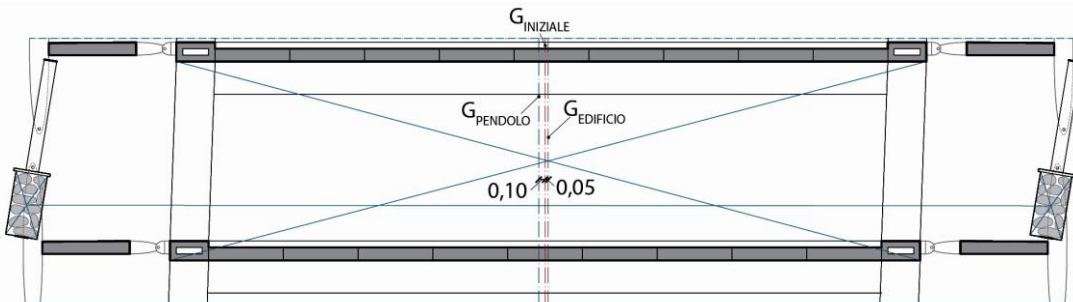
Schema dinamica pendolo sul piano tipo di riferimento.
